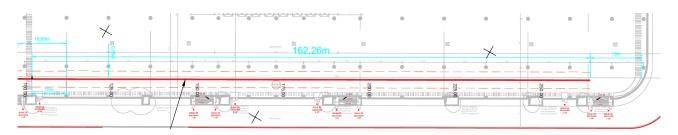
Vue en plan dans le bâtiment (source : ARTELIA)
